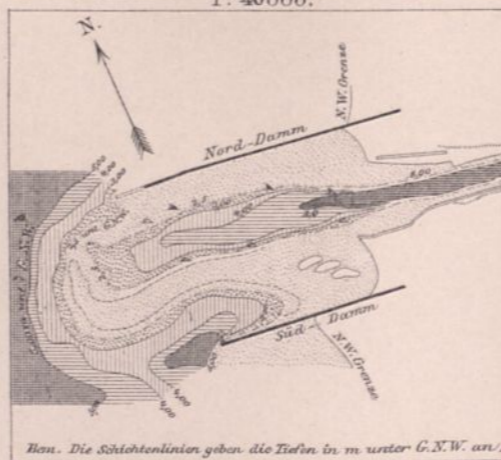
Lageplan der neuen Maasmündung am Hoek van Holland.
